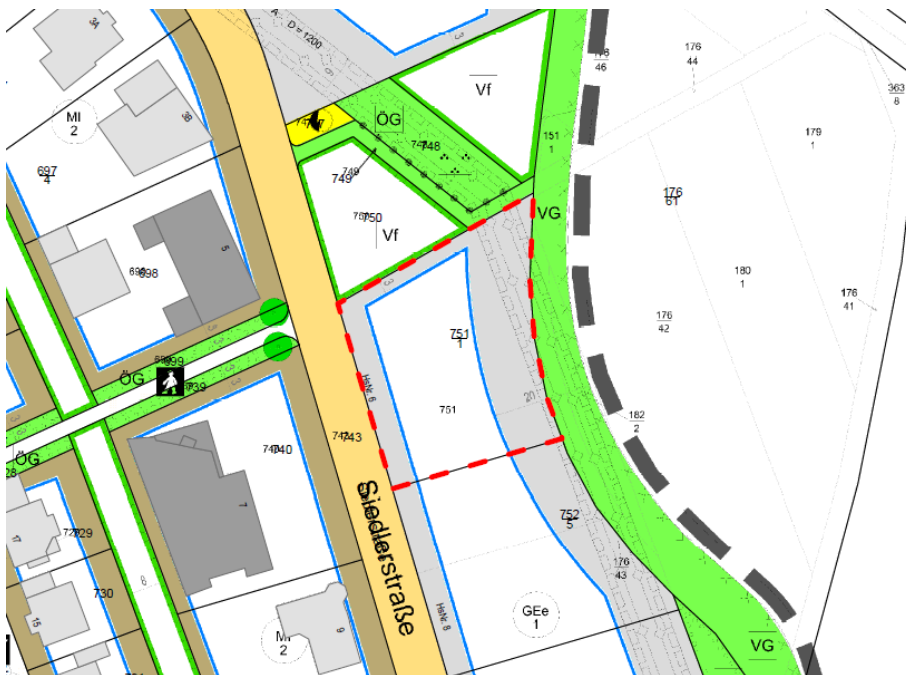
rechtskräftiger Bebauungsplan 69 B - 02 „Bei der Oberlache West – 2. Änderung“ mit aktuellem Kataster und eingezeichnetem Geltungsbereich der vorliegenden Planung
